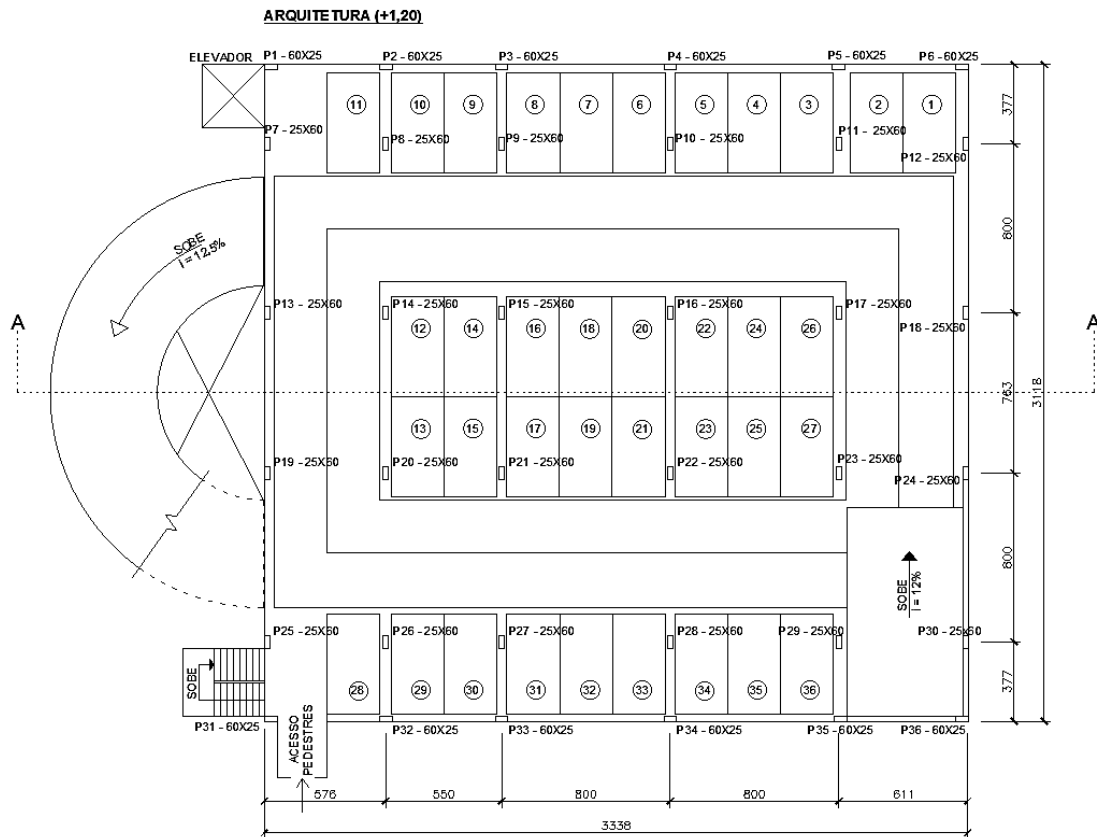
Planta baixa do pavimento térreo (medidas em cm).
